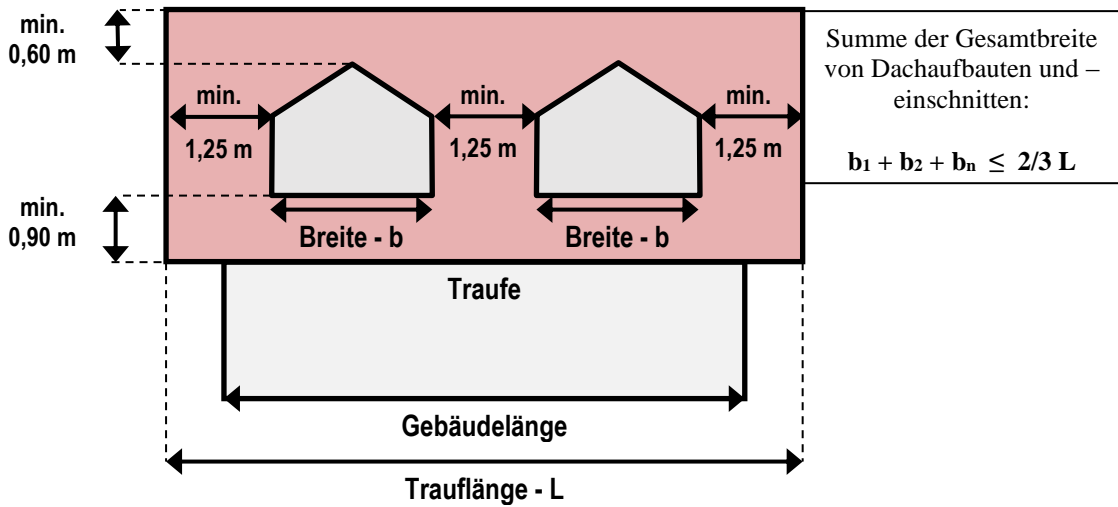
Abmessungen zulässiger Dachgauben (hier Beispiel: Sattelgaube)
